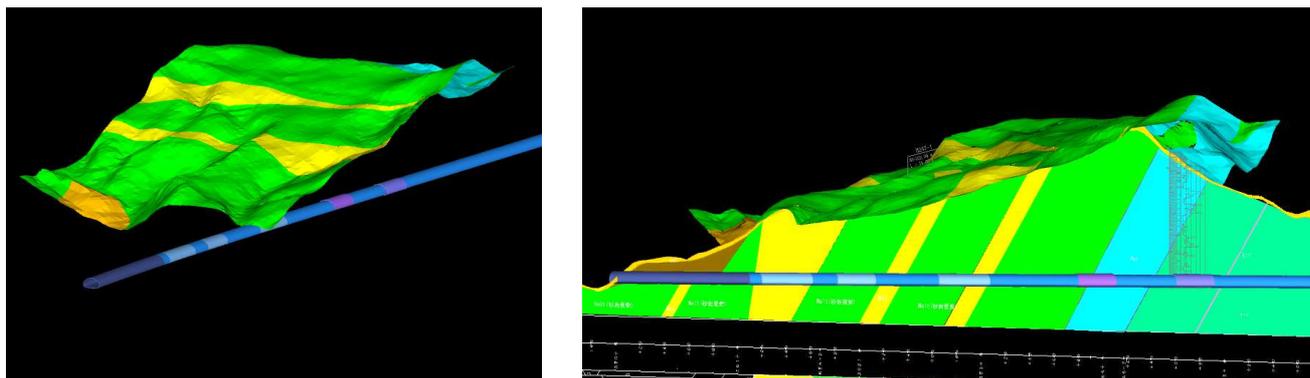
地表踏査平面図のモデル（左）と地質縦断面図を重ねたモデル（右）
